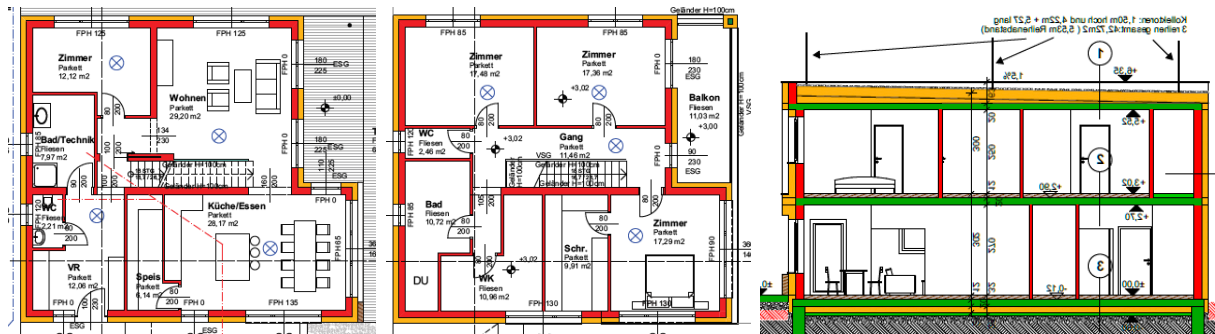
Grundriss EG (links), Grundriss OG (mitte), und Schnitt (rechts) des Solarhauses Josk (Quelle: Einreichplan)
